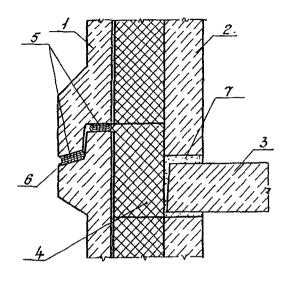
Лабиринтный горизонтальный стык трехслойных панелей наружных стен с гибкими связями:
